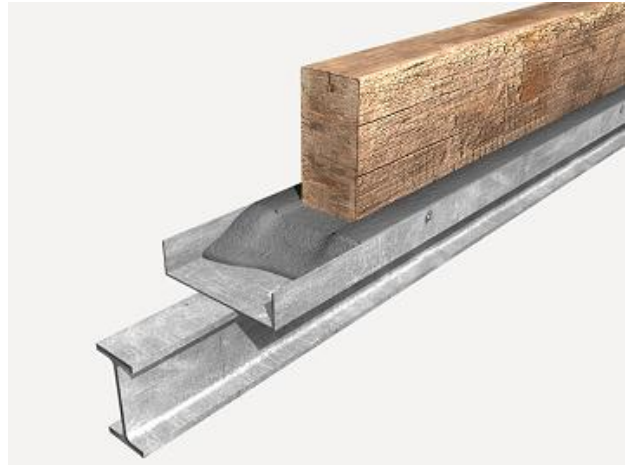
Detalle constructivo refuerzo, Generador de precios Cype
